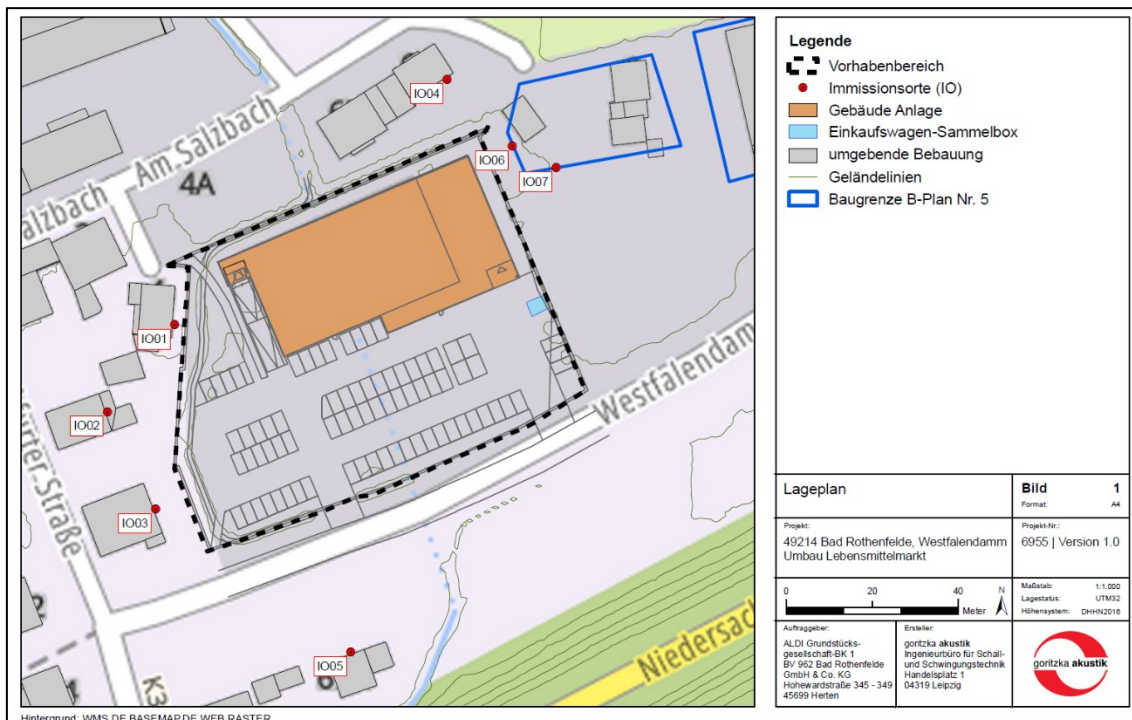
Lageplan der schalltechnischen Untersuchung, maßgebliche Immissionsorte
